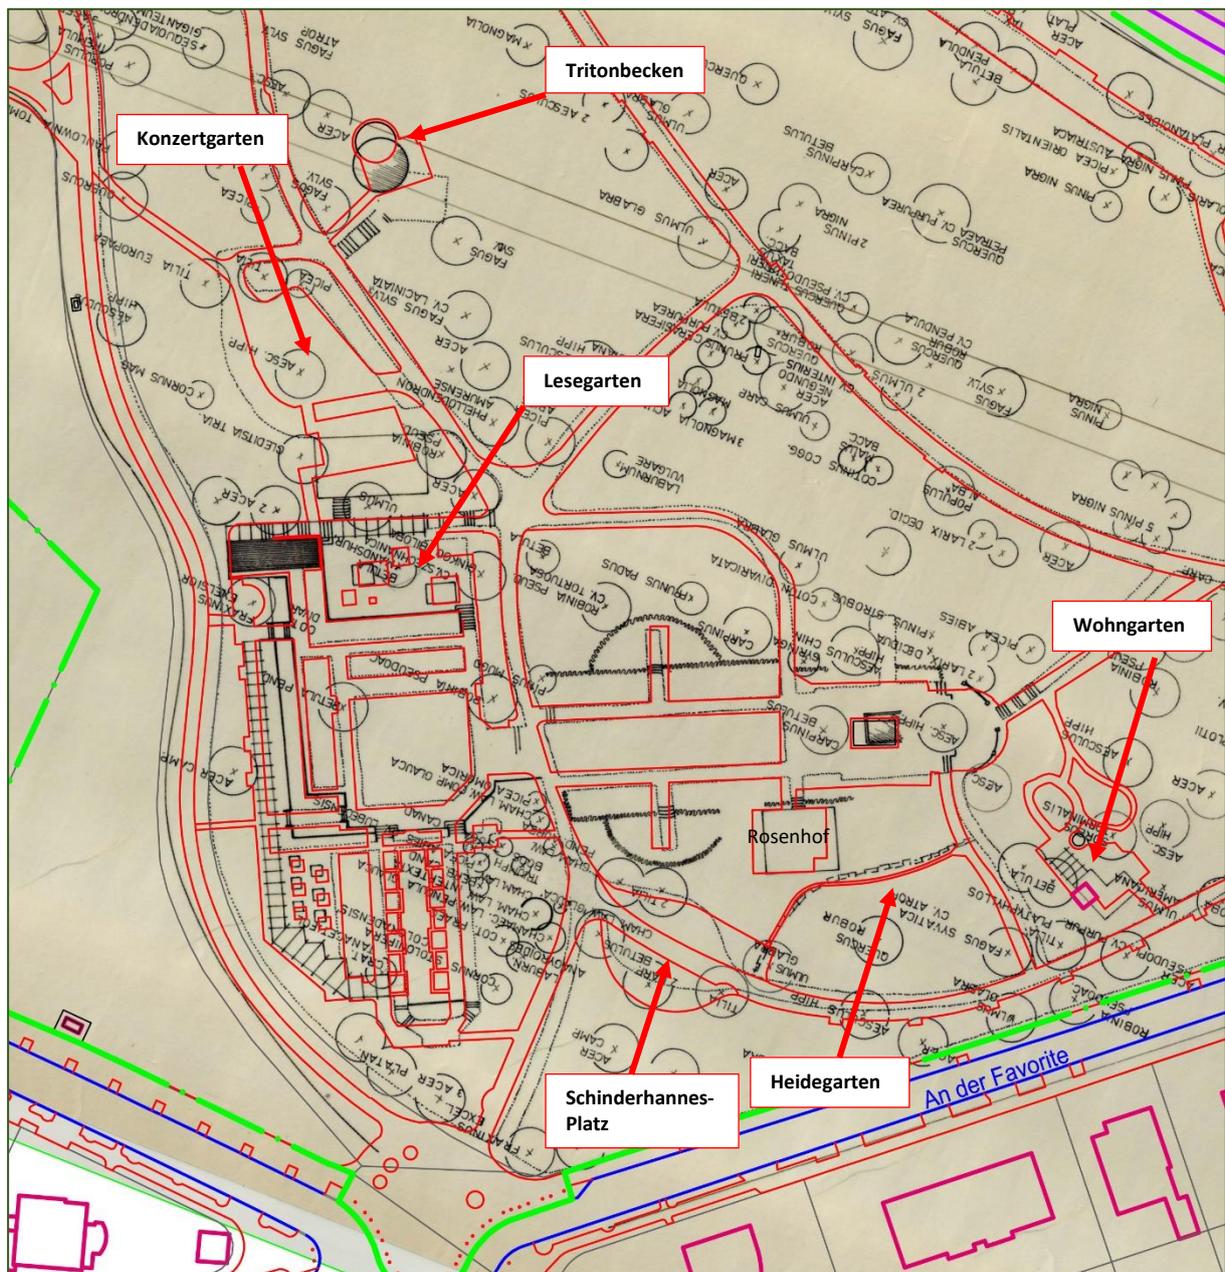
Planüberlagerung 1963 - 2022, Ausschnitt
